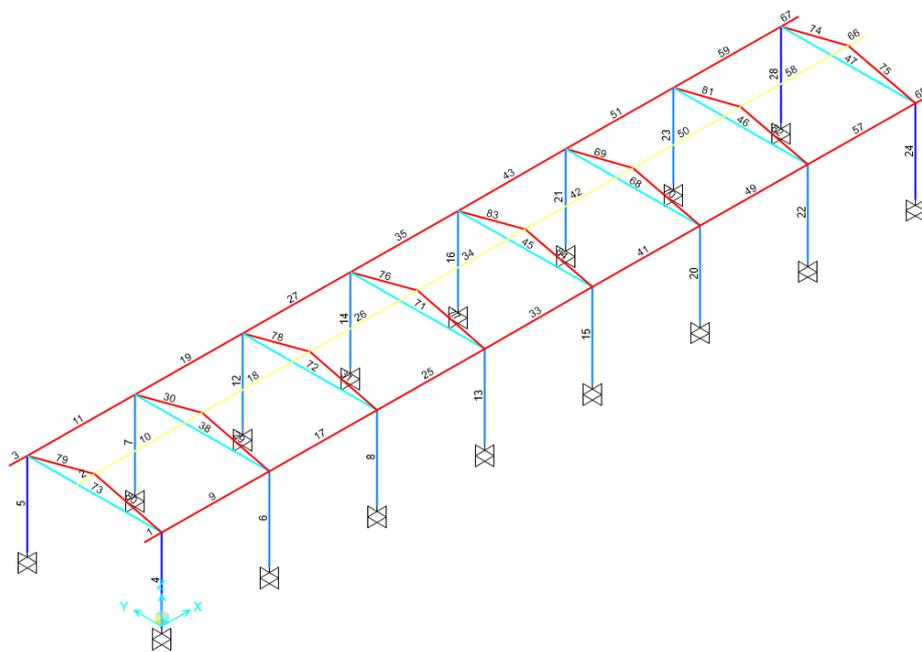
Vista assometrica del modello di elevazione – numerazione elementi frame
